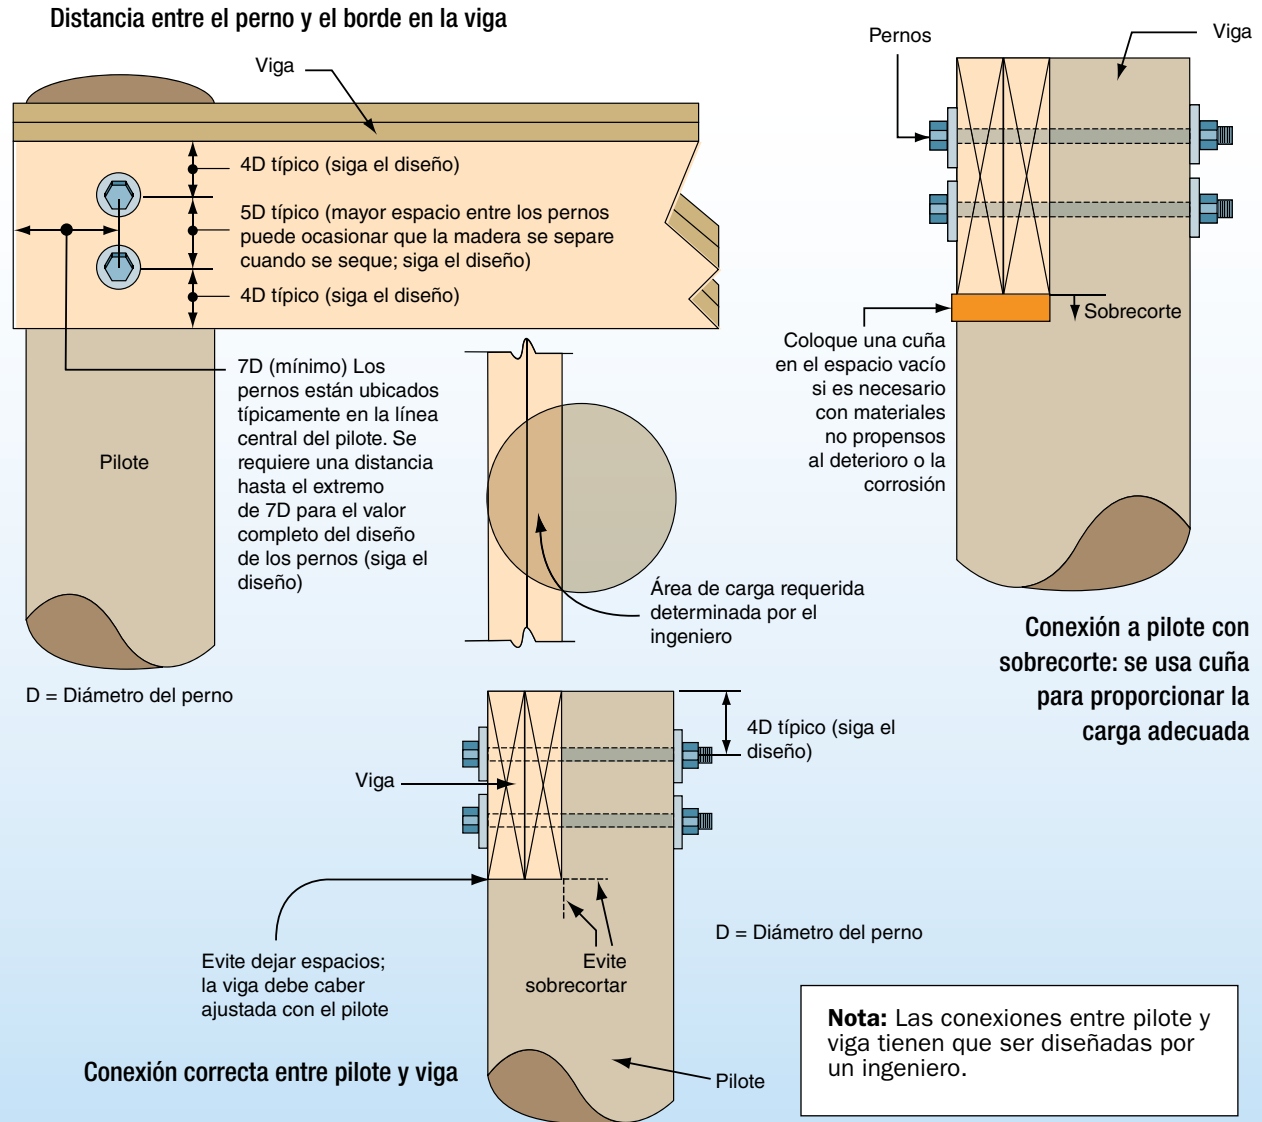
Conexión correcta entre pilote y viga sujetada con pernos.
